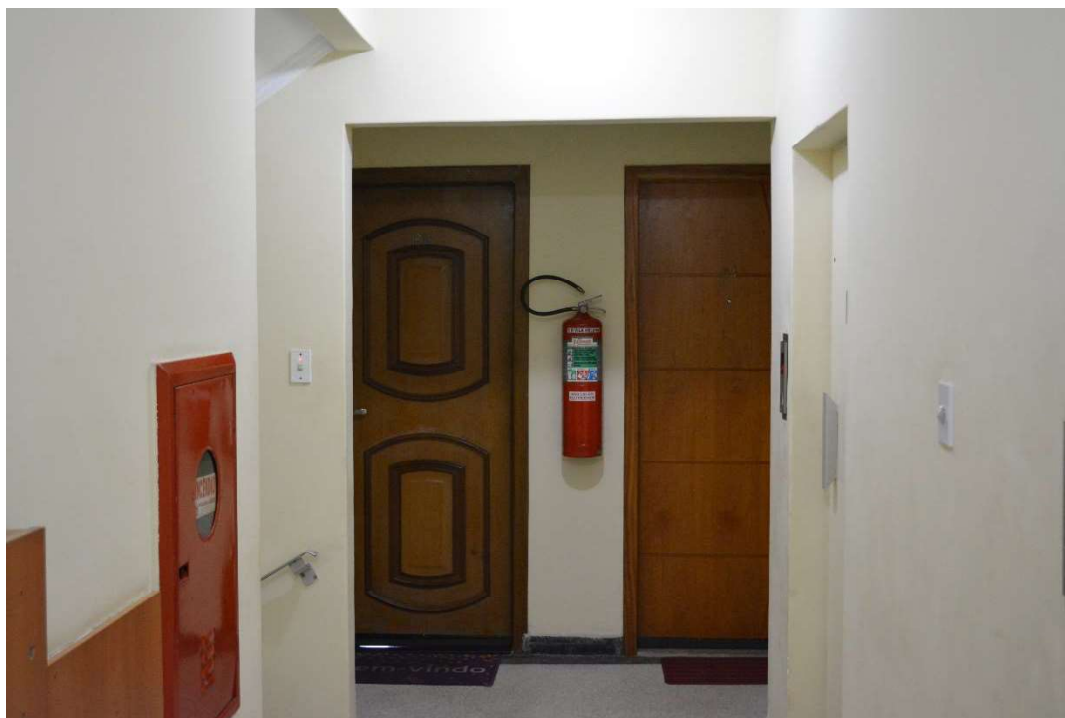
VISTA DO HALL DO 6º PAVIMENTO PARA A UNIDADE AVALIANDA, À ESQUERDA.
